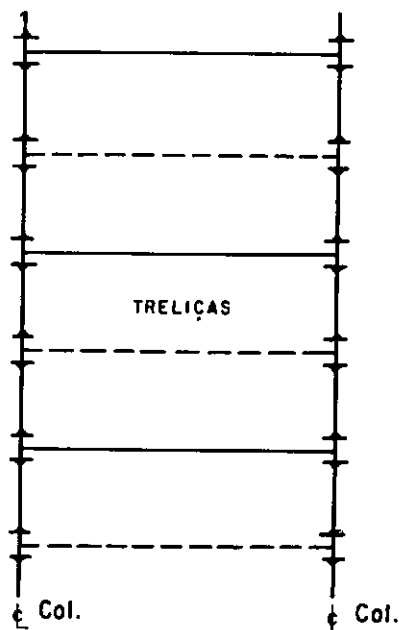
DISPOSIÇÃO EM PLANTA PARA O SISTEMA DE CONTRAVENTAMENTO COM TRELIÇAS ALTERNADAS.
